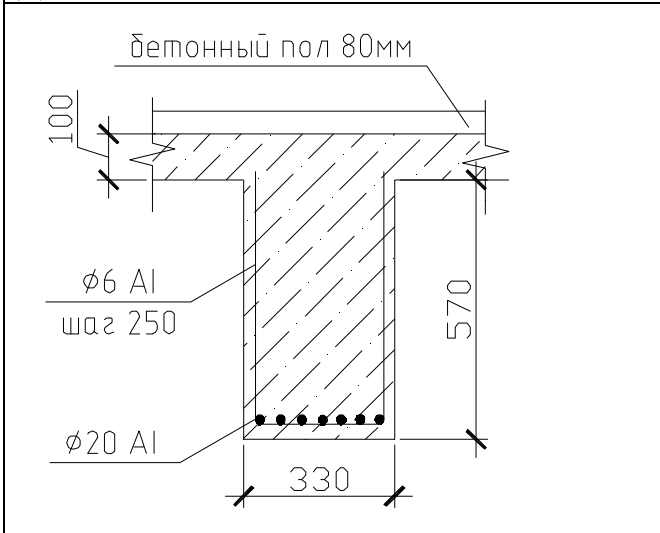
Главная балка ж/б перекрытия над вторым этажом в осях «8-11/А-Б, В-Г»
